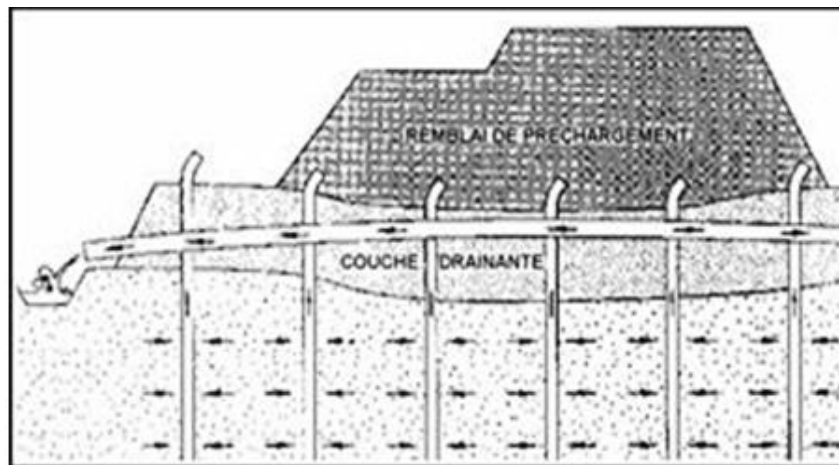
Schéma présente le principe du drainage vertical. [3]
